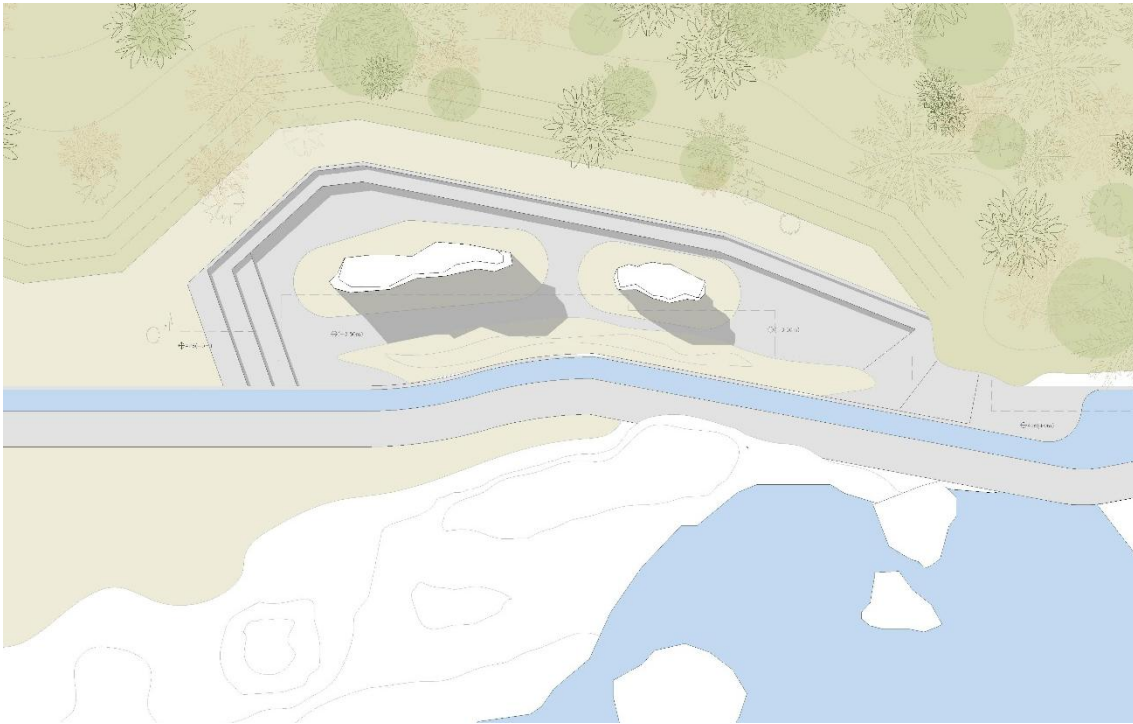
Planta do Bouldering Gym. - Imagem de Autor
